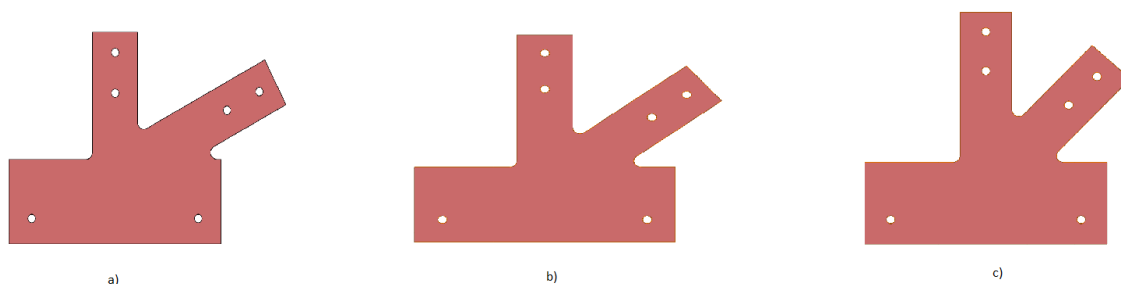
Chapas de aço: a) ligação 6; b) ligação 7; c) ligação 8.
